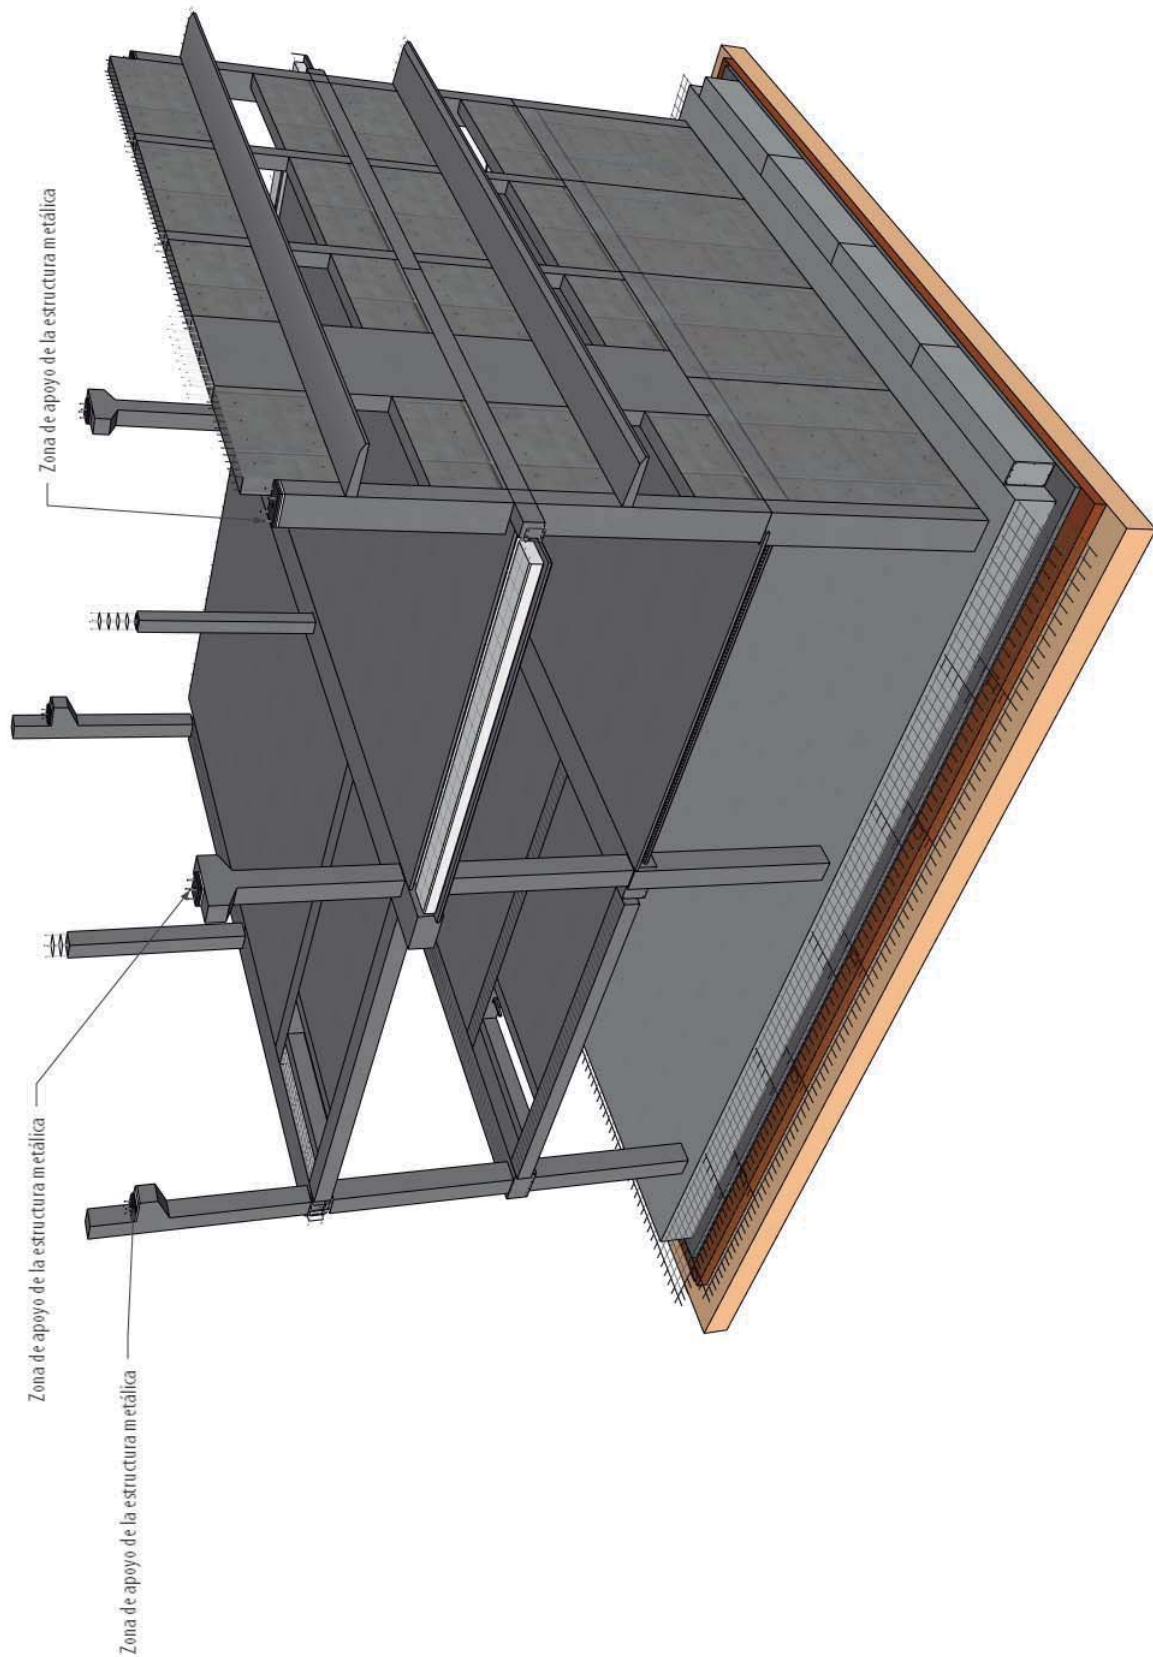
Hormigonado de los pilares y muros que soportarán la estructura metálica
